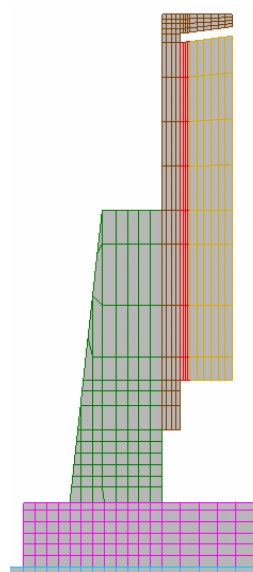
Corte transversal da proposta de reforço tipo 2
